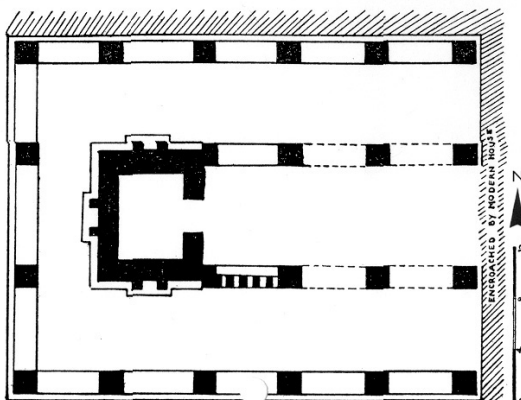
Grundriss Gauḍarguḍi-Tempel/Aihole
